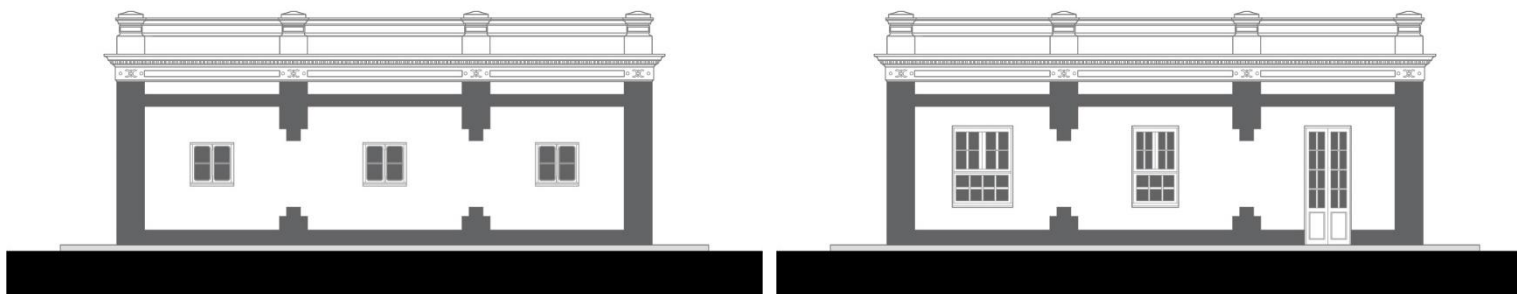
e 05.26: Fachadas oeste e leste.
